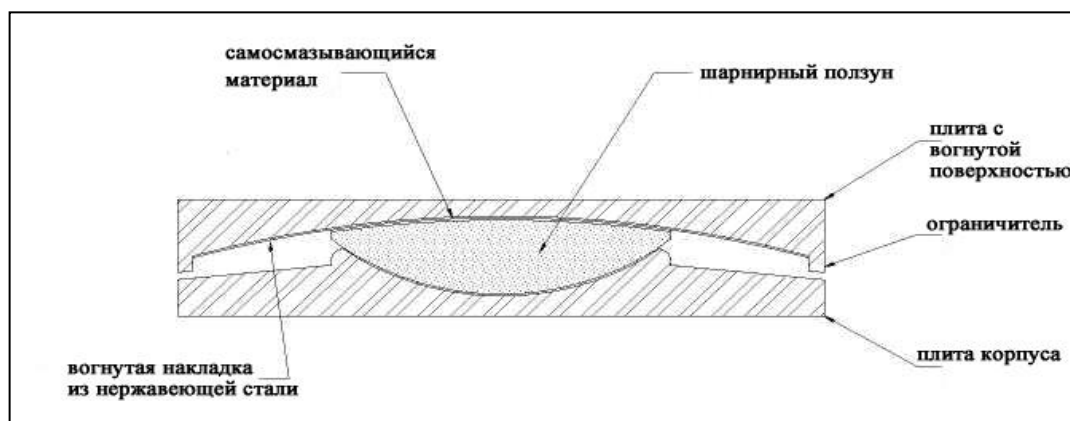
Схема устройства фрикционного маятникового подшипника (ФМП)
